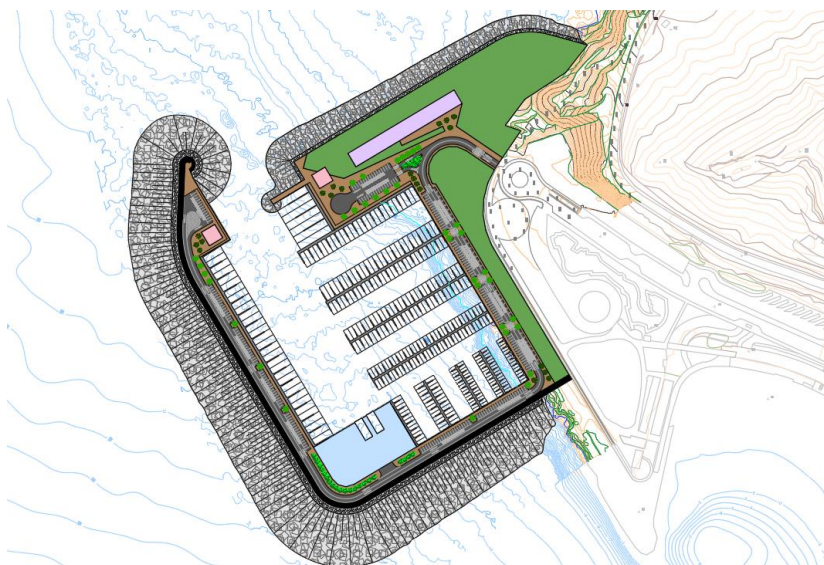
Disposición general en planta del nuevo puerto deportivo de Tauro
